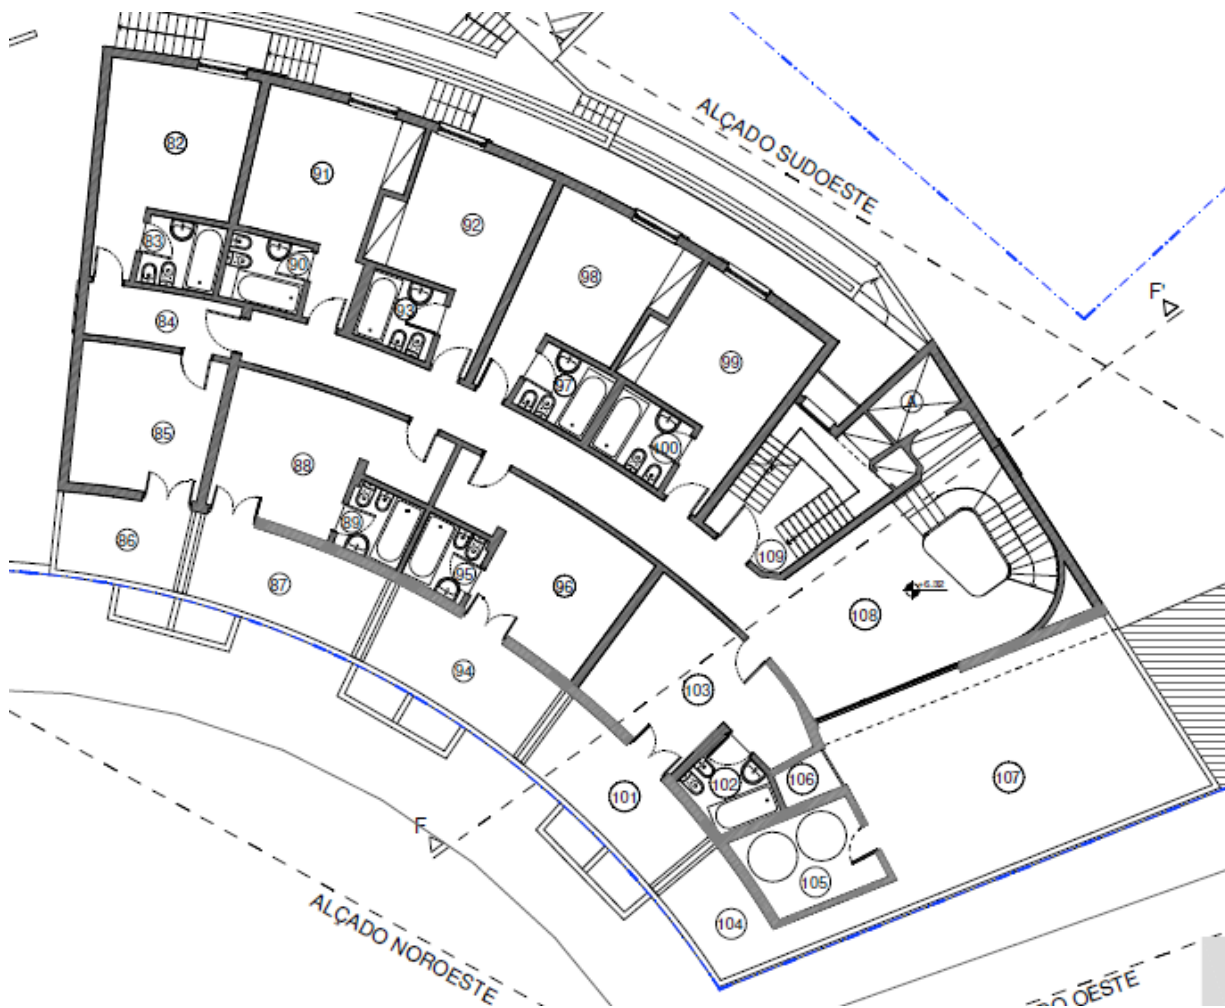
Planta do piso 2 - Edifício existente [Atelier B2, 2016]
